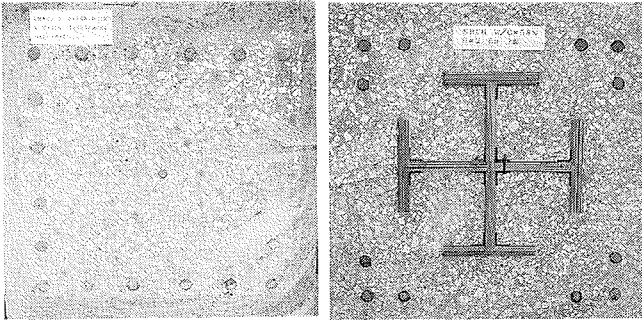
コンクリートの充填状況 (RC 造) 写真-5 コンクリートの充填状況 (SRC 造)
